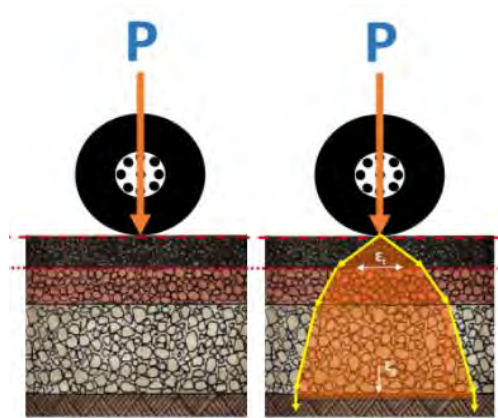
Distribución de esfuerzos en pavimento flexible (Pacasmayo, 2009)
